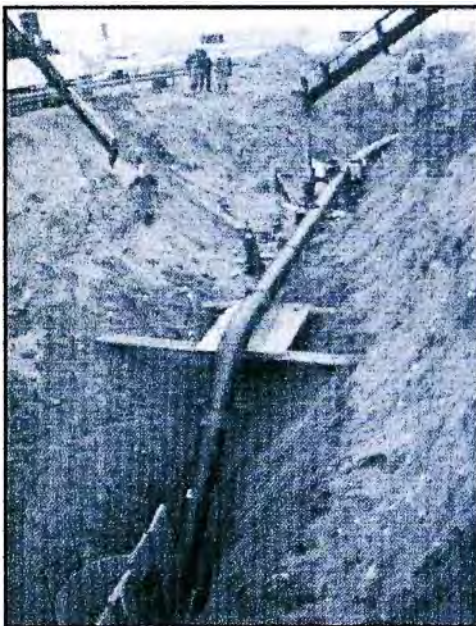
Cambio de dirección en plano vertical y horizontal
